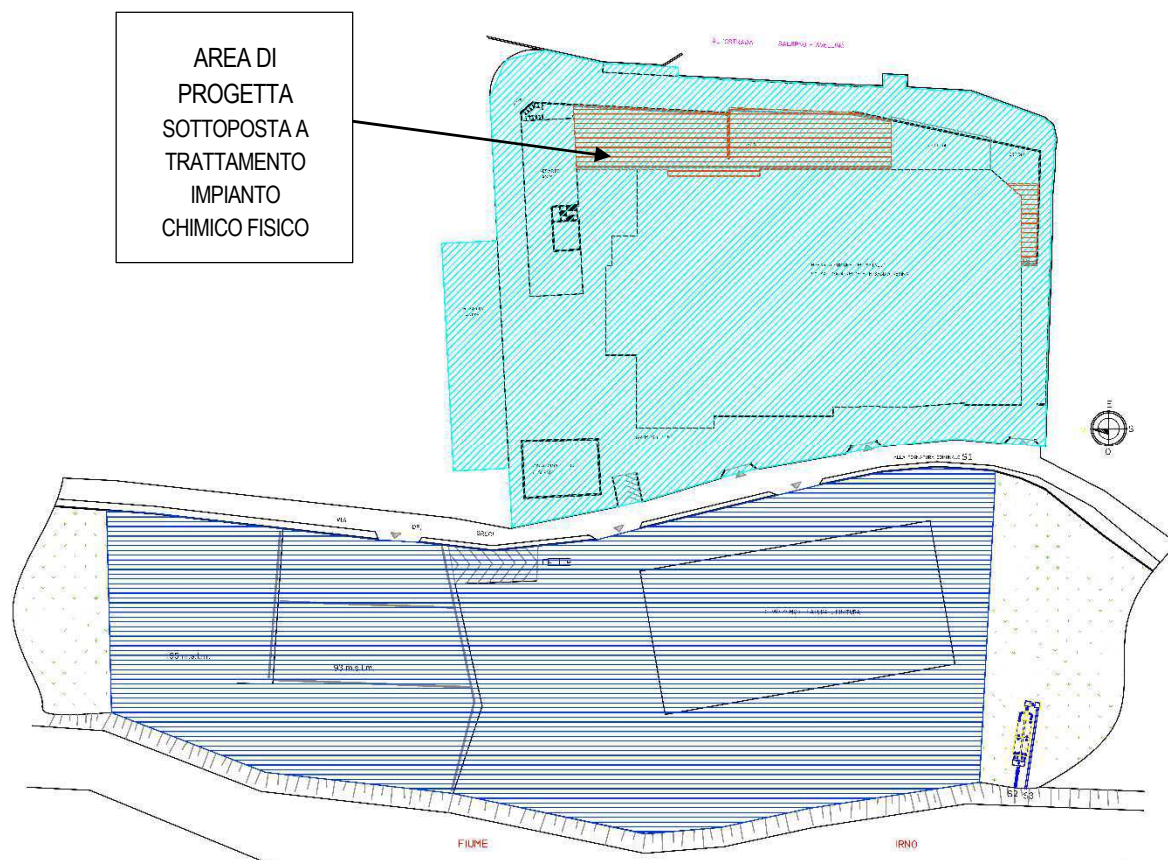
Stralcio planimetrico con indicazione delle superfici scolanti – STATO DI PROGETTO
